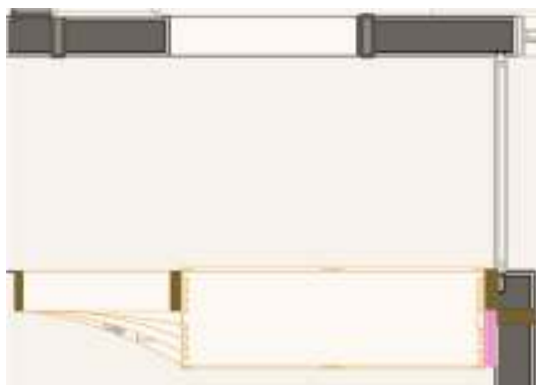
\_Planta baixa com coluna passa fio em destaque.
